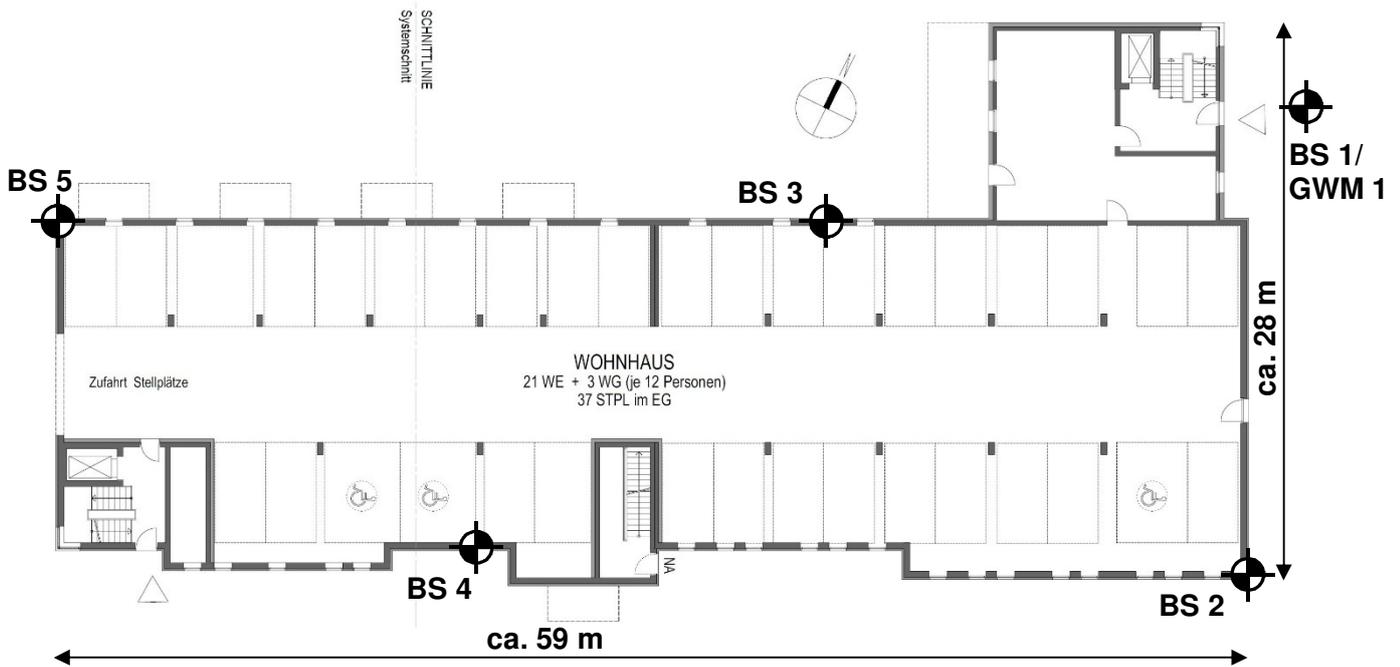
Erdgeschossgrundriss Haus 3, M 1:375
